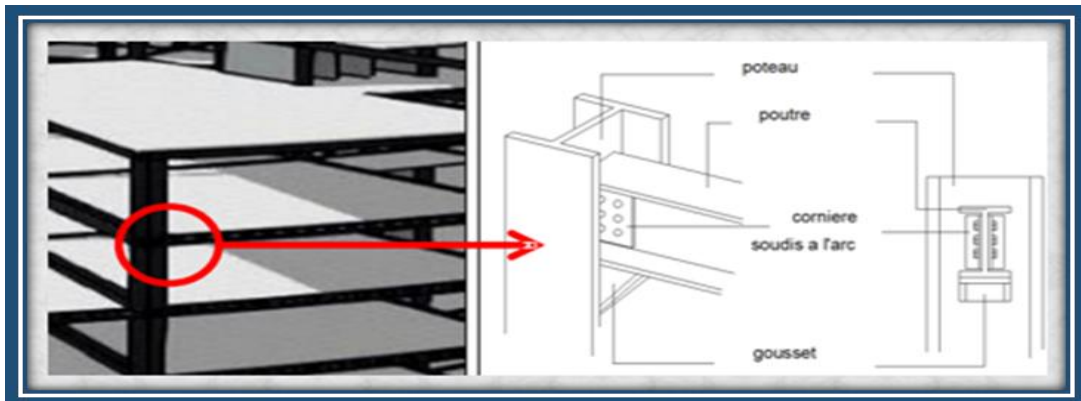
Assemblage poteau-poutre      Source :cours construction (Blida M1 2016) professeur Tarzali.
